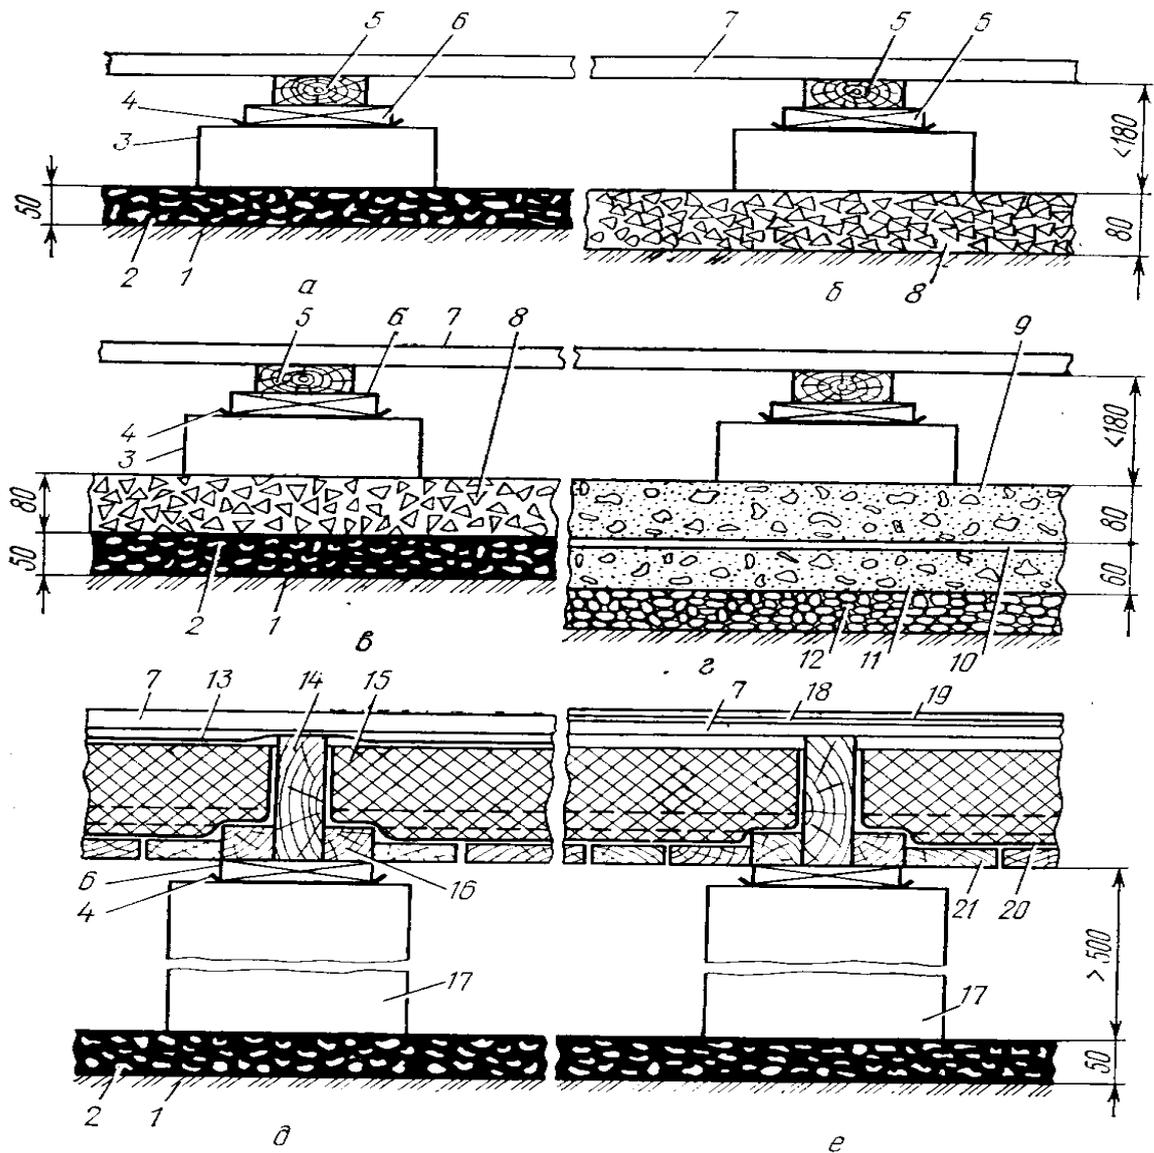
Конструкции полов над утепленным (а...г) и холодным (д...е) подпольем: 1 – грунт основания; 2 – слой щебня с пропиткой битумом или дегтем; 3 – бетонная или кирпичная подкладка; 4 – гидроизоляция из 2 слоев толя на дегтевой мастике; 5 – лага; 6 – подкладка; 7 – доски пола; 8 – подстилающий слой из гравия или щебня; 9 – подстилающий слой из бетона марки 100; 10 – гидроизоляция (изол, гидроизол на прослойке из битумной мастике или толь на прослойке из дегтевой мастике); 11 – стяжка из бетона марки 100; 12 – щебень, втрамбованный в грунт; 13 – пароизоляция (синтетические пленочные материалы или толь); 14 – балка перекрытия; 15 – утеплитель; 16 – черепной брусок; 17 – бетонный или кирпичный столбик; 18 – ДВП марки Т-350 на клеющей мастике; 19 – линолеум или поливинилхлоридные плитки; 20 –
